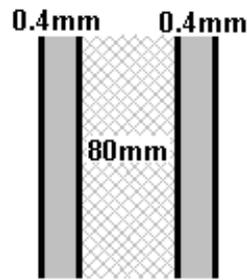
Constitución de planchas prefabricadas para paredes y techo
